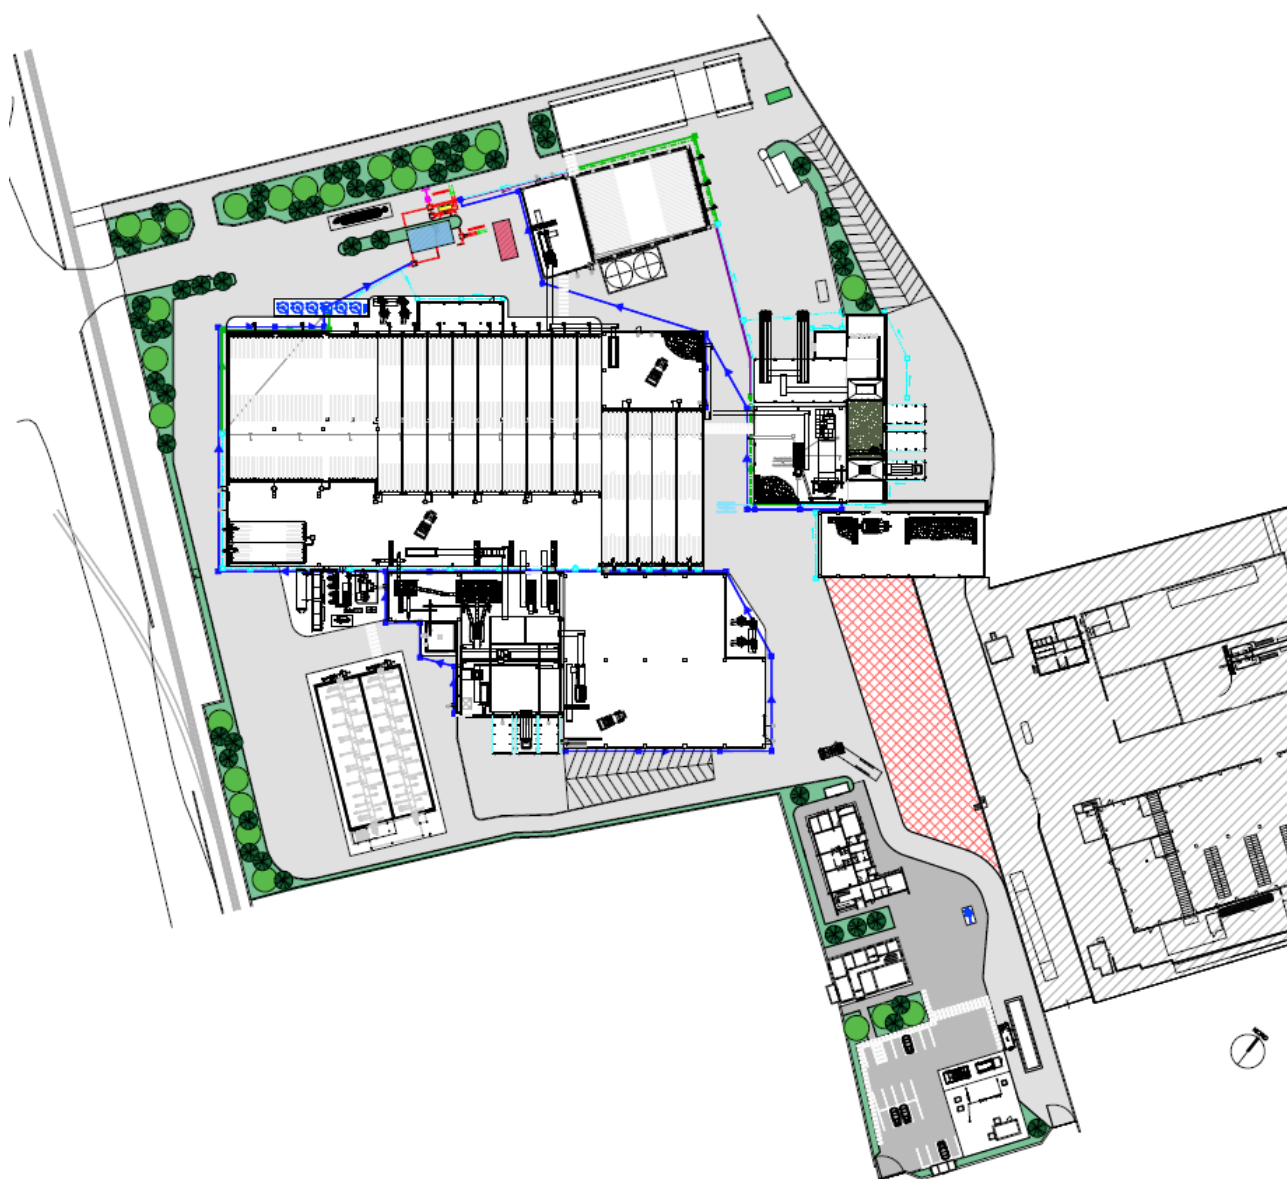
Planimetria rete acque meteoriche dei tetti di progetto
